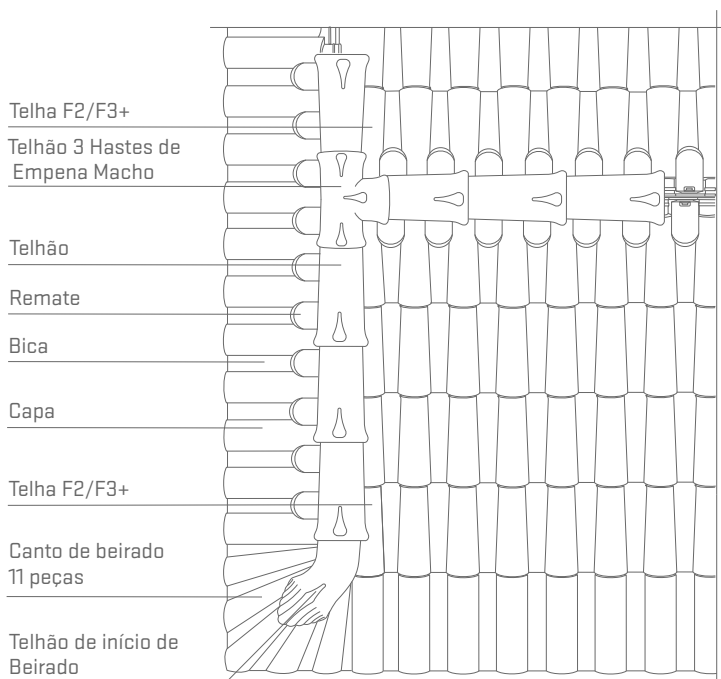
Acabamento das empenas com beirado à portuguesa e telha dupla F2/F3+
